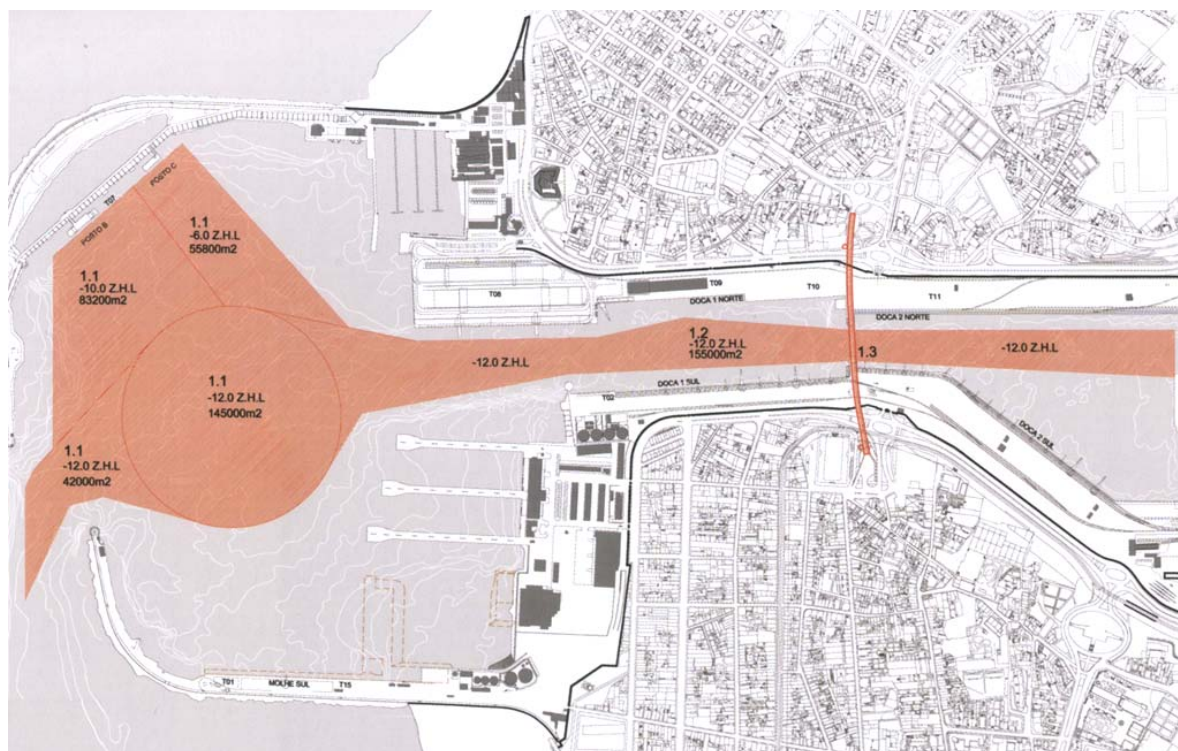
Planta geral da Acção 01 - Fonte: APDL
